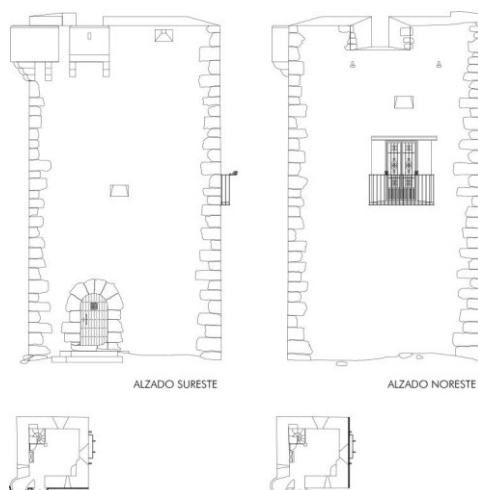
Estado actual. Alzados Sureste y Noreste (authors: J. Prior & V.M. Llombart, 2018)
